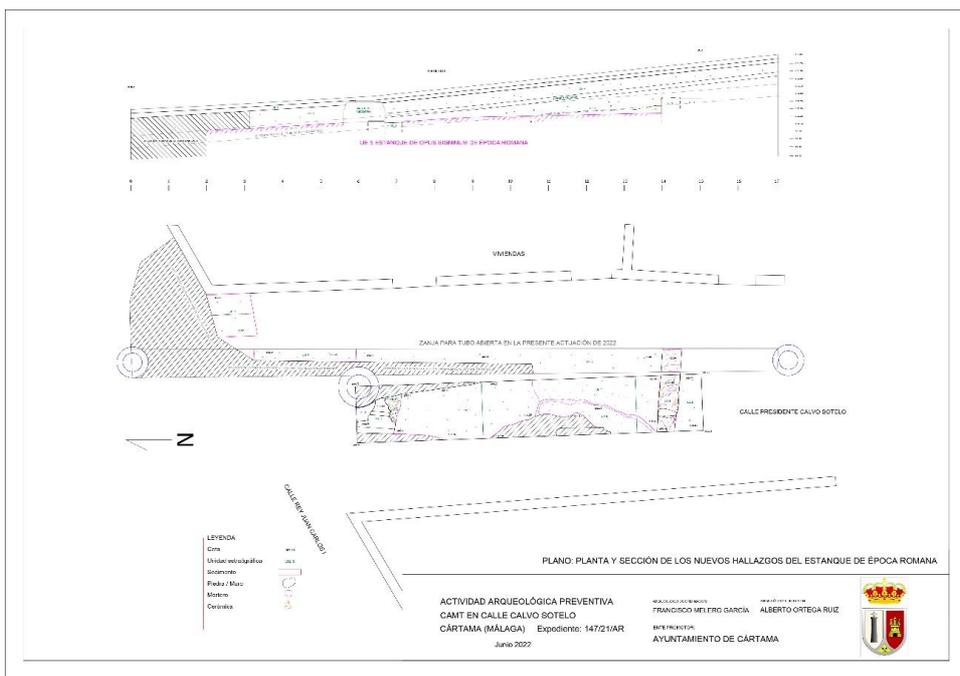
Planta y alzado de los restos del estanque de época romana.
